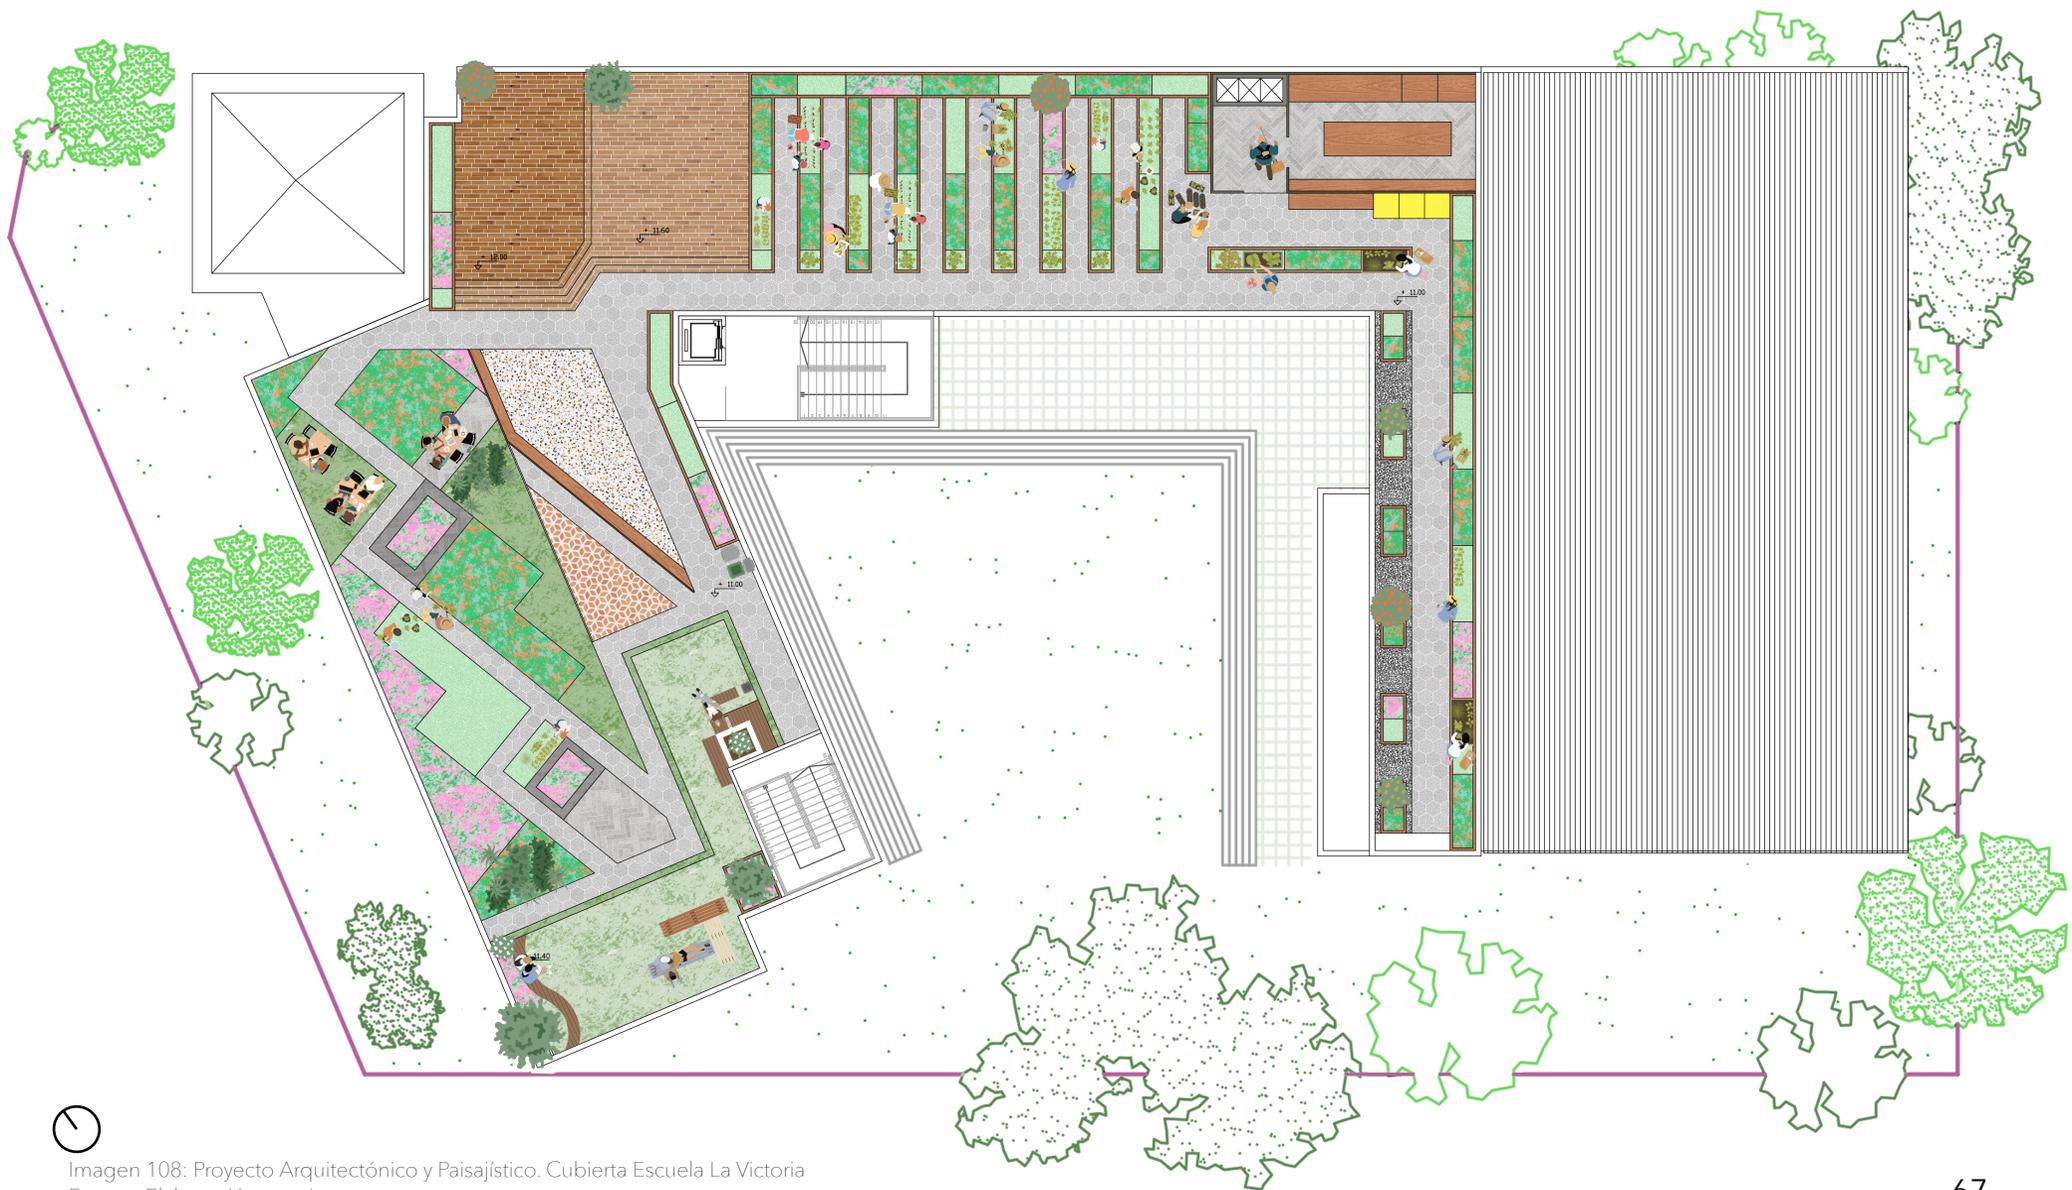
Proyecto Arquitectónico y Paisajístico. Cubierta Escuela La Victoria
